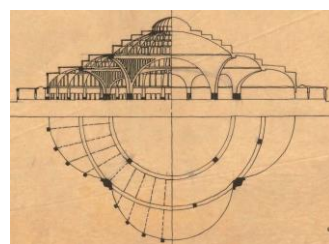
M.ベルク「百年記念ホール」断面図、平面図
